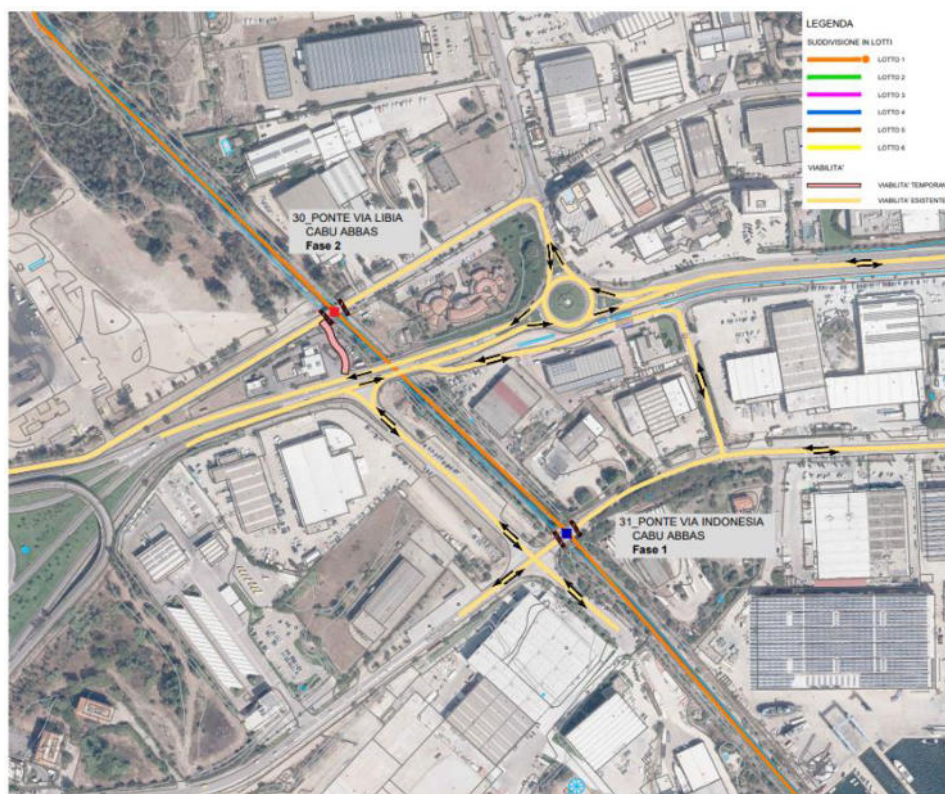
Attraversamenti cantiere di Cabu Abbas nel Lotto n°1
